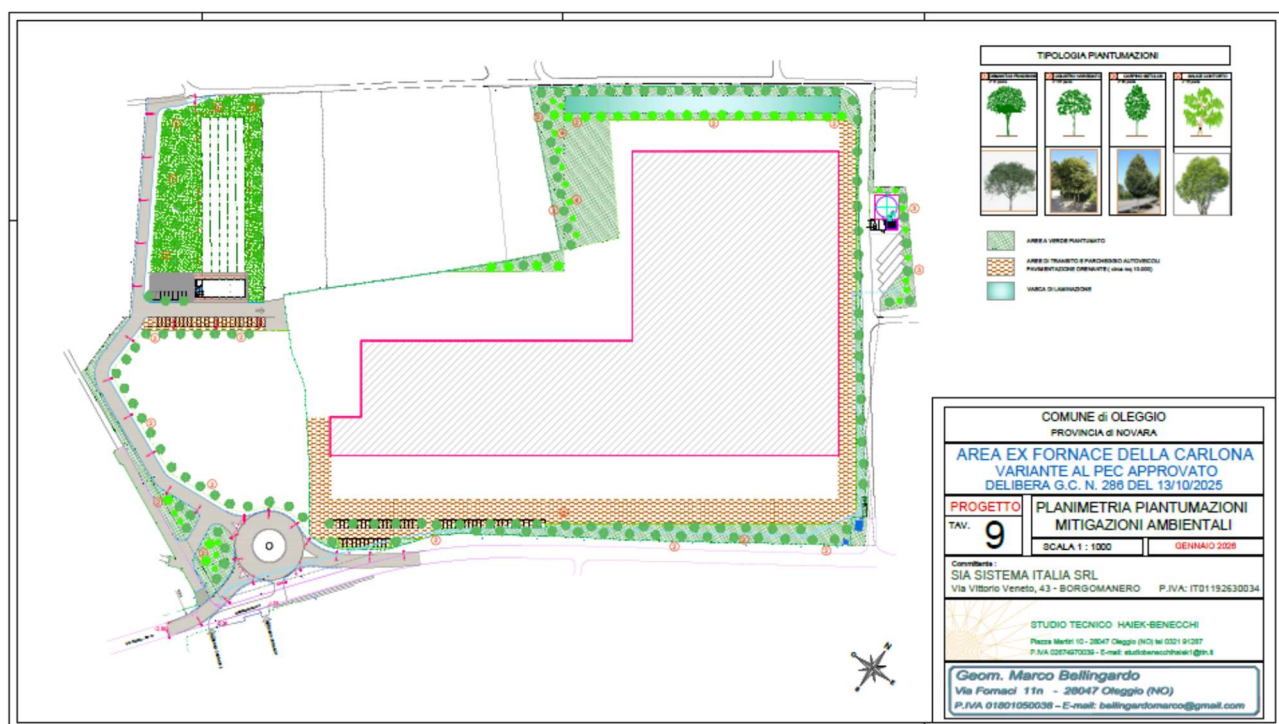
planimetria di progetto – piantumazioni e vasca di laminazione.
